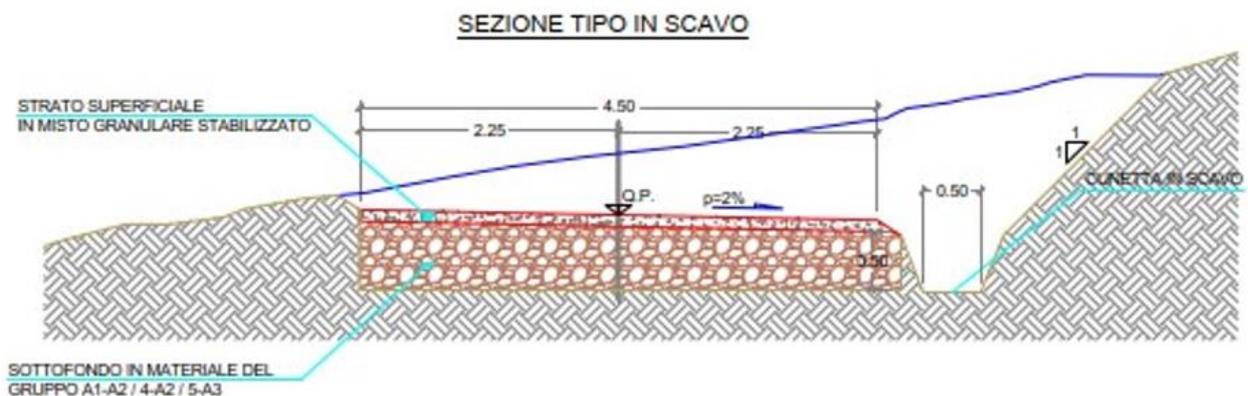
Sezione stradale "tipo" IN SCAVO della viabilità di progetto (strade di accesso alle piazzole e relativo pacchetto stradale)
